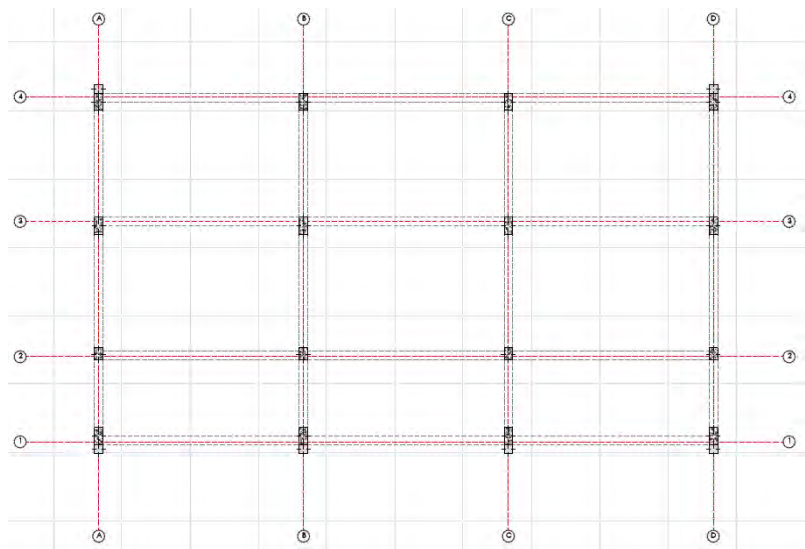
RED CONSTRUCTIVA - AULAS
